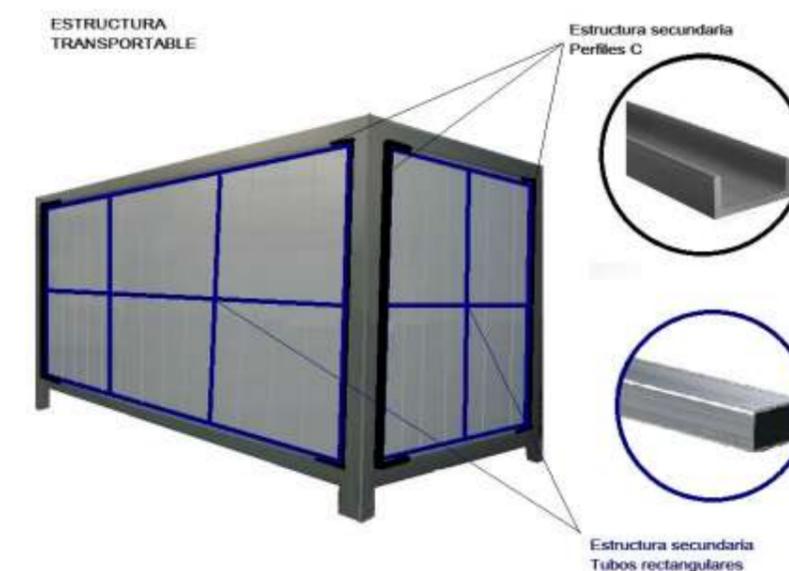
Estructura módulo de vivienda- Estructura Principal
